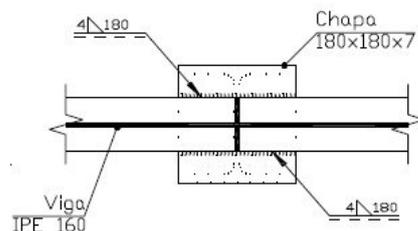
Unión viga-pilar con chapa soldada
